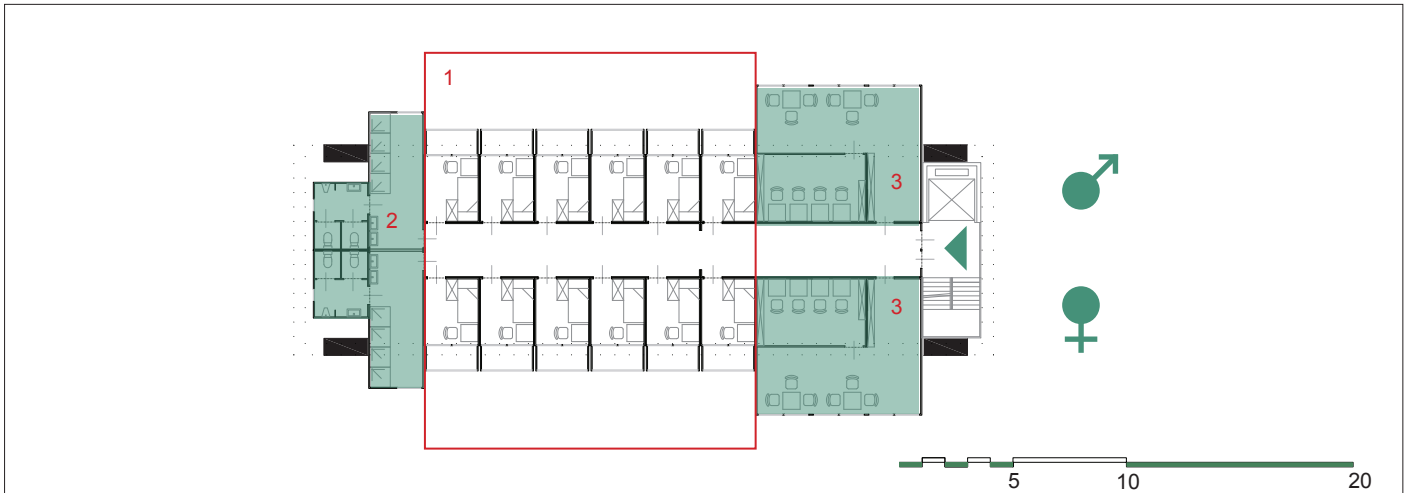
Grundrissvariation OG 3 - einfache Ausführung
